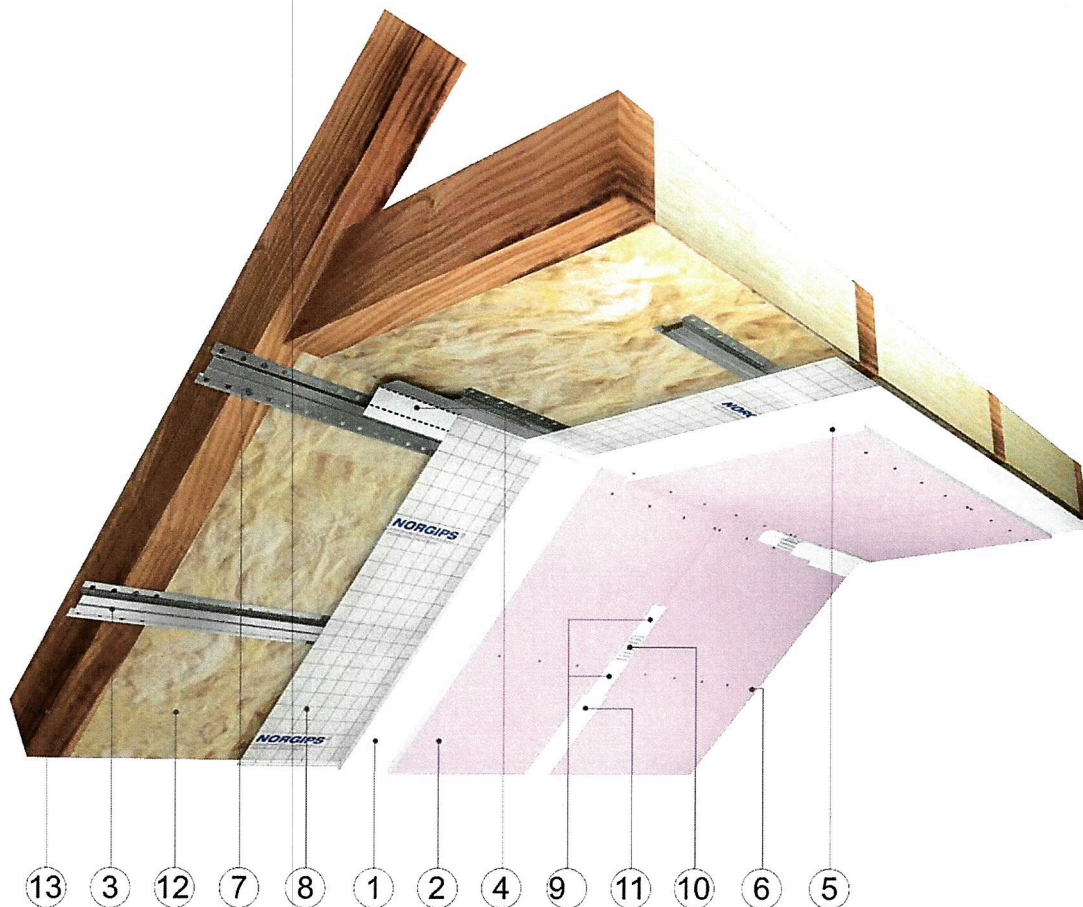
Widok zabudowy dachu na konstrukcji z profili CD 60 i wieszakach płaskich typu L
